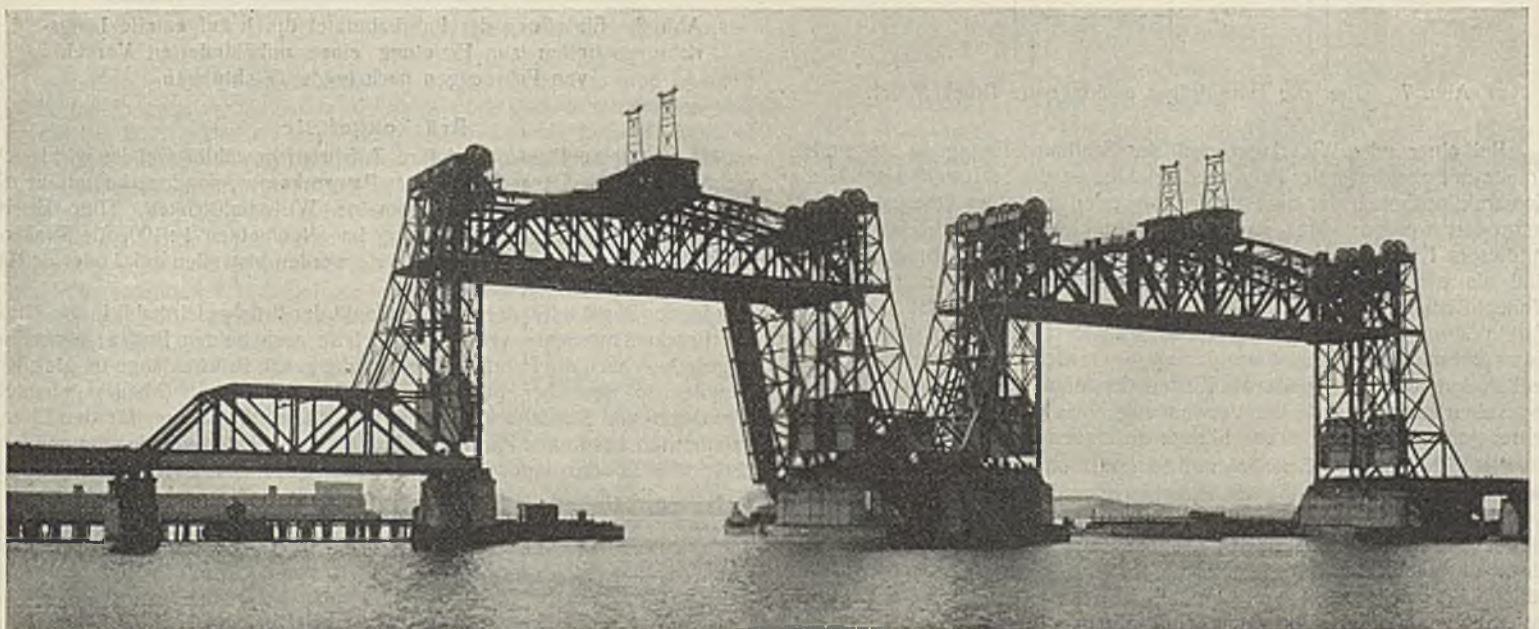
Hubbrücken der Central-Railroad of New Jersey über die Newark-Bay. Vier zweigleisige voneinander unabhängige Hubbrücken.
